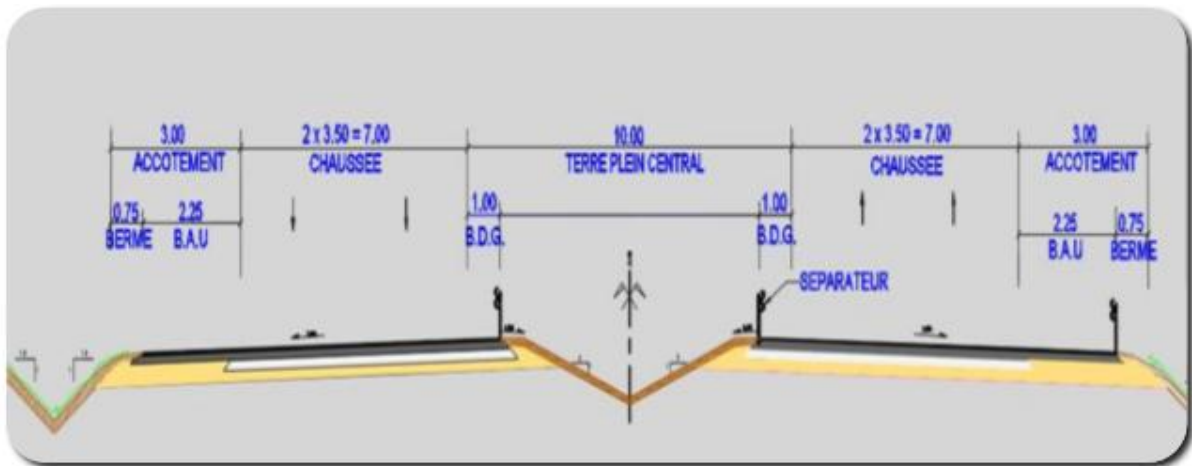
Schéma explicatif d'une Coupe transversale de la chaussée prévue.
